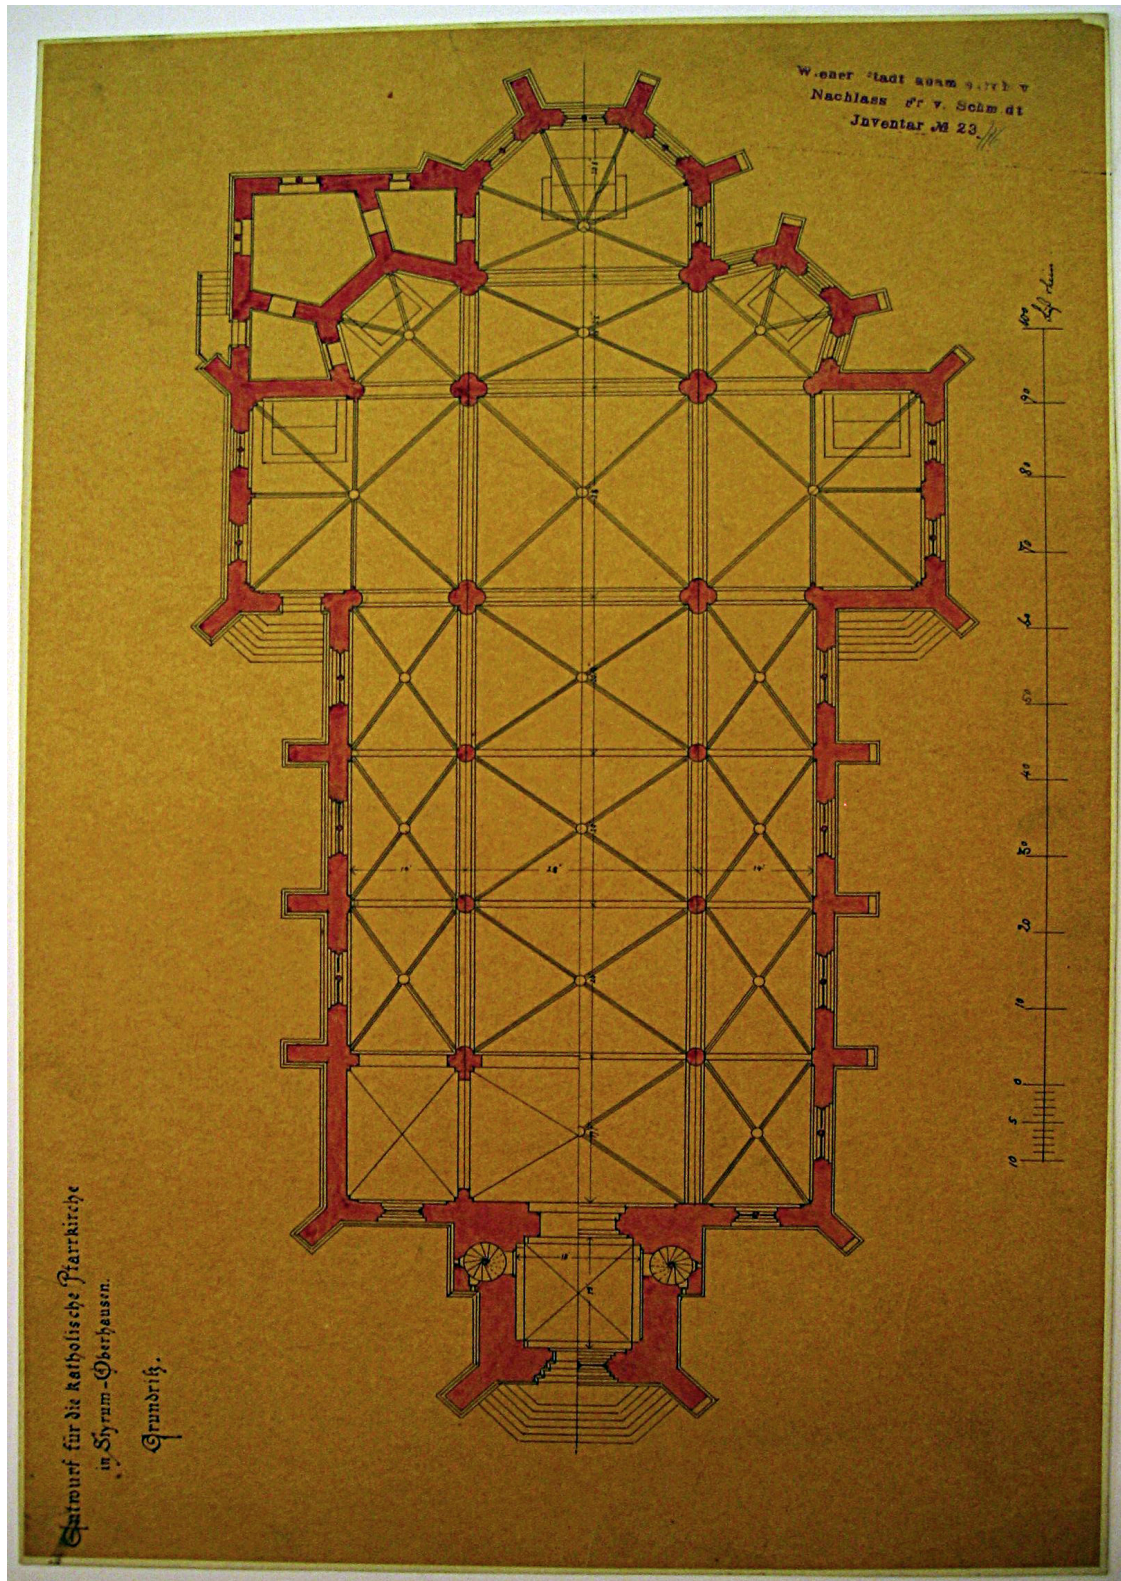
WM, Inv.-Nr. 157.23/16 dritter Entwurf, Grundriss
